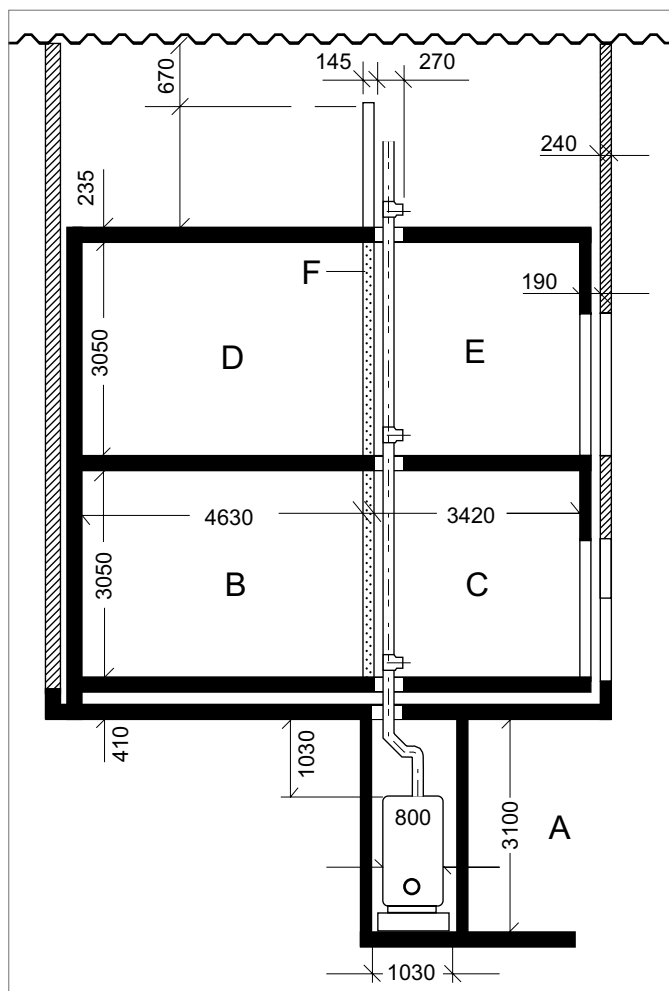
Testopstelling van de installatie van het Fraunhofer-Institut für Bauphysik (maten en mm)
